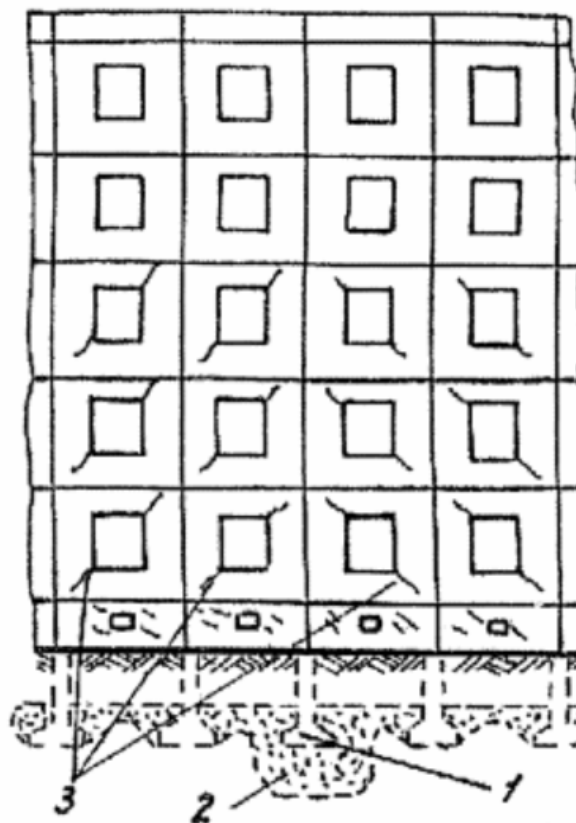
Схема трещин в стене крупнопанельного здания от неравномерной осадки фундаментов:
